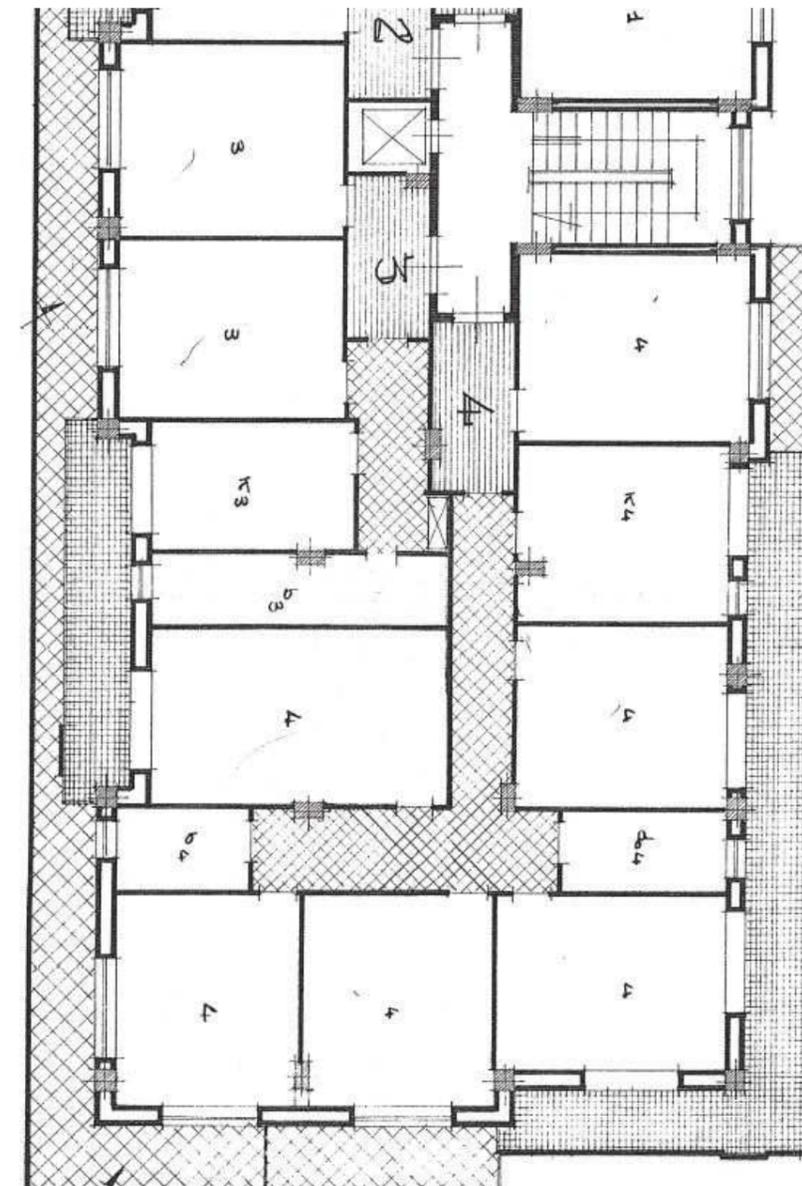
Grafico piano tipo dell'Autorizzazione edilizia del 09/05/1963
